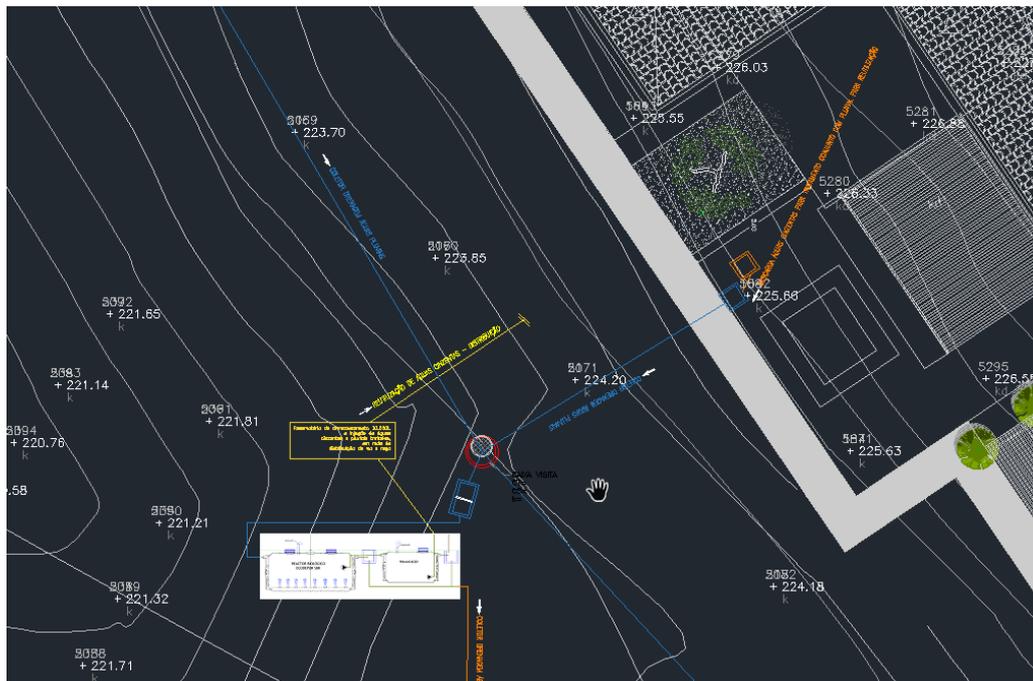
Sistema de recolha e armazenamento (30m<sup>3</sup>) das águas pluviais a instalar nas edificações do Aparthotel
